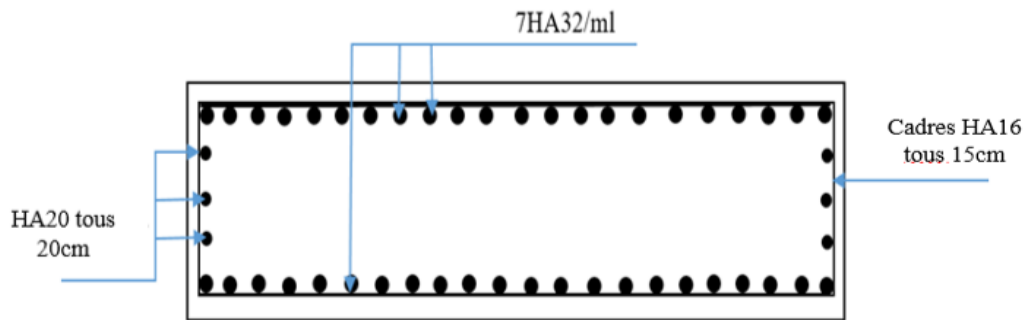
FERRAILLAGE TRANSVERSALE DES FUTS
